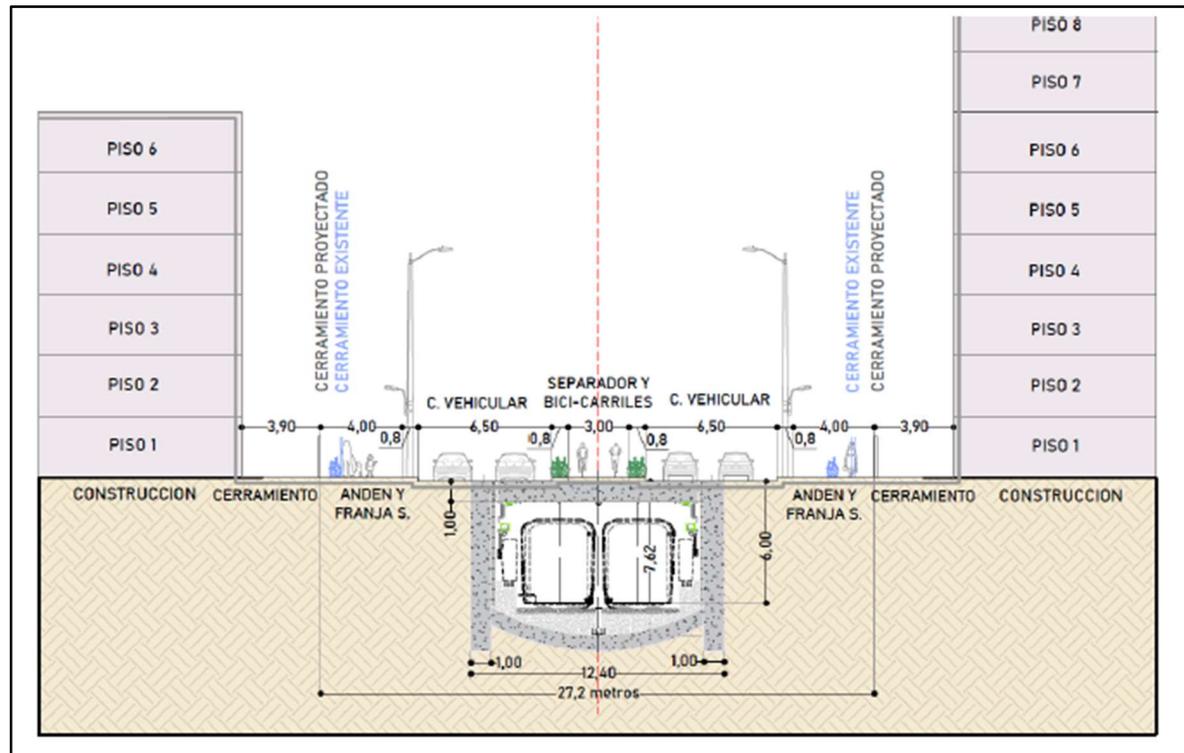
Tramo 8 – Perfil vial proyectado V2 – Túnel férreo entre pantallas
